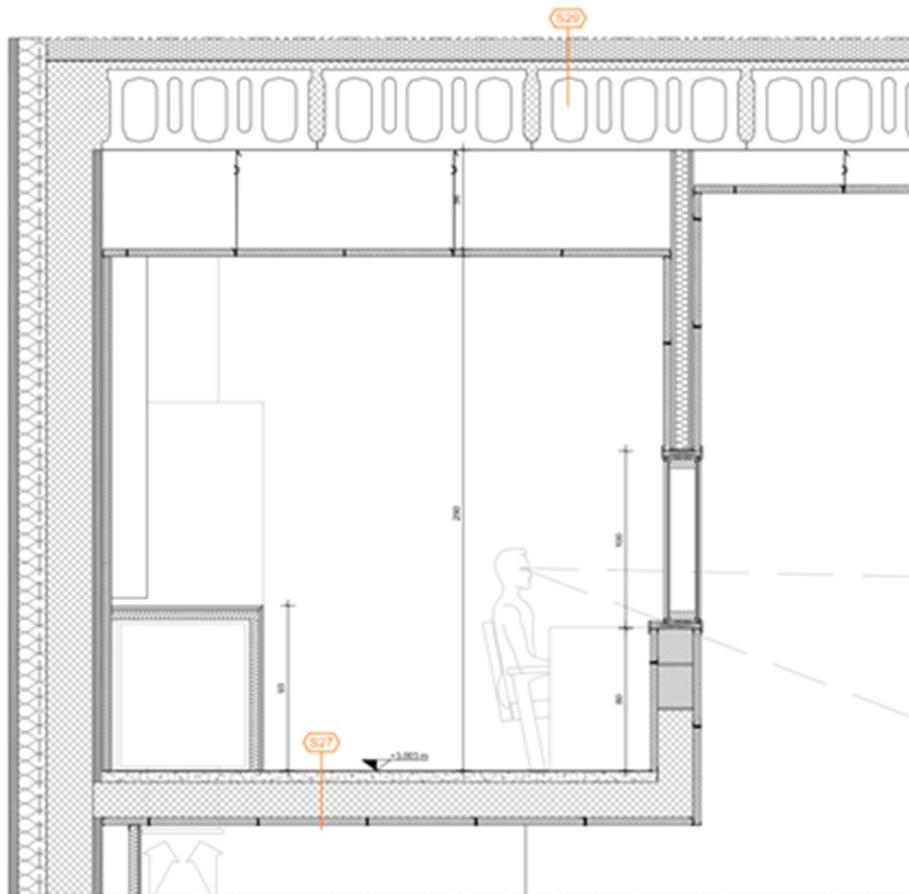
Dettaglio serramento ad elevato potere fonoisolante tra sala regia e auditorium
